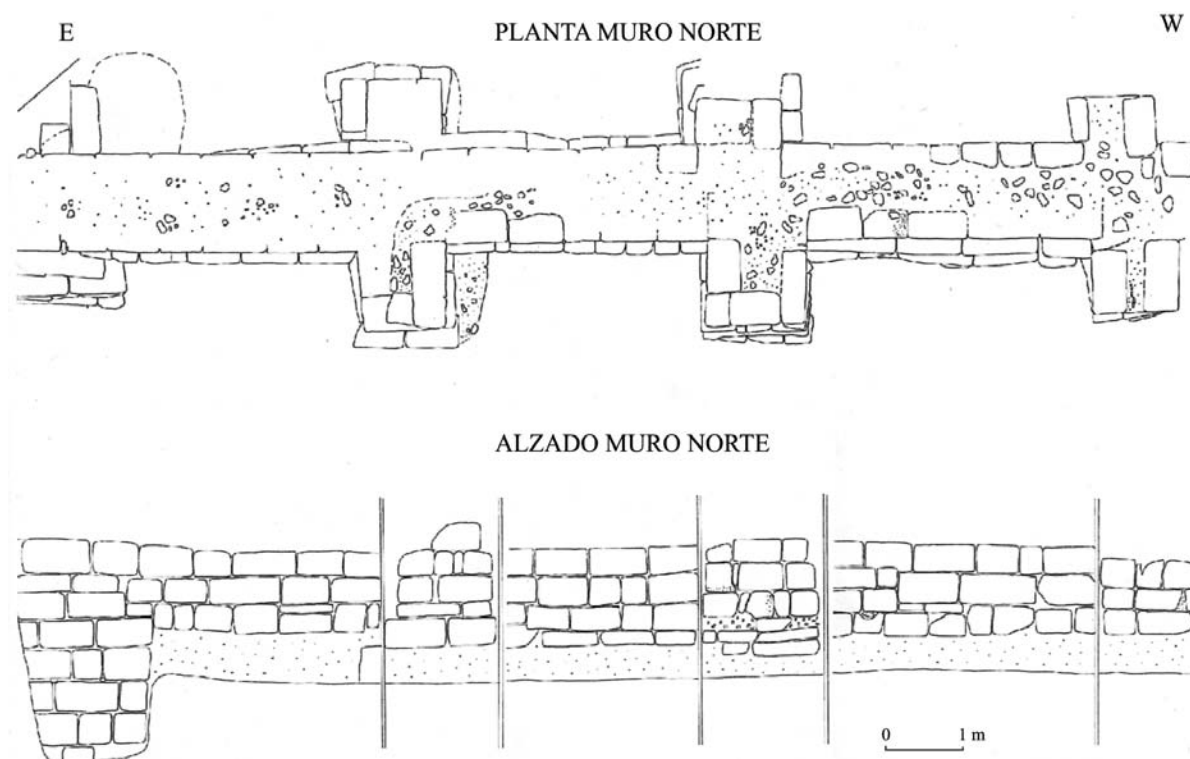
Alzado y planimetría de la unidad constructiva 10.
